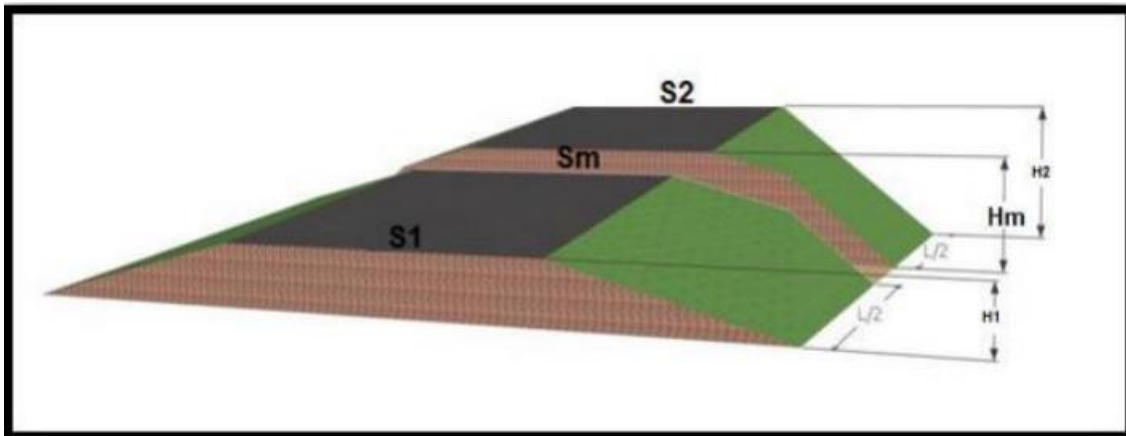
Les sections des profils en travers d'un tracé donné.
